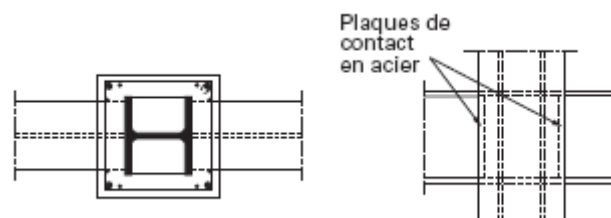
Assemblage d'un poteau mixte totalement enrobé de béton et d'une poutre en acier
